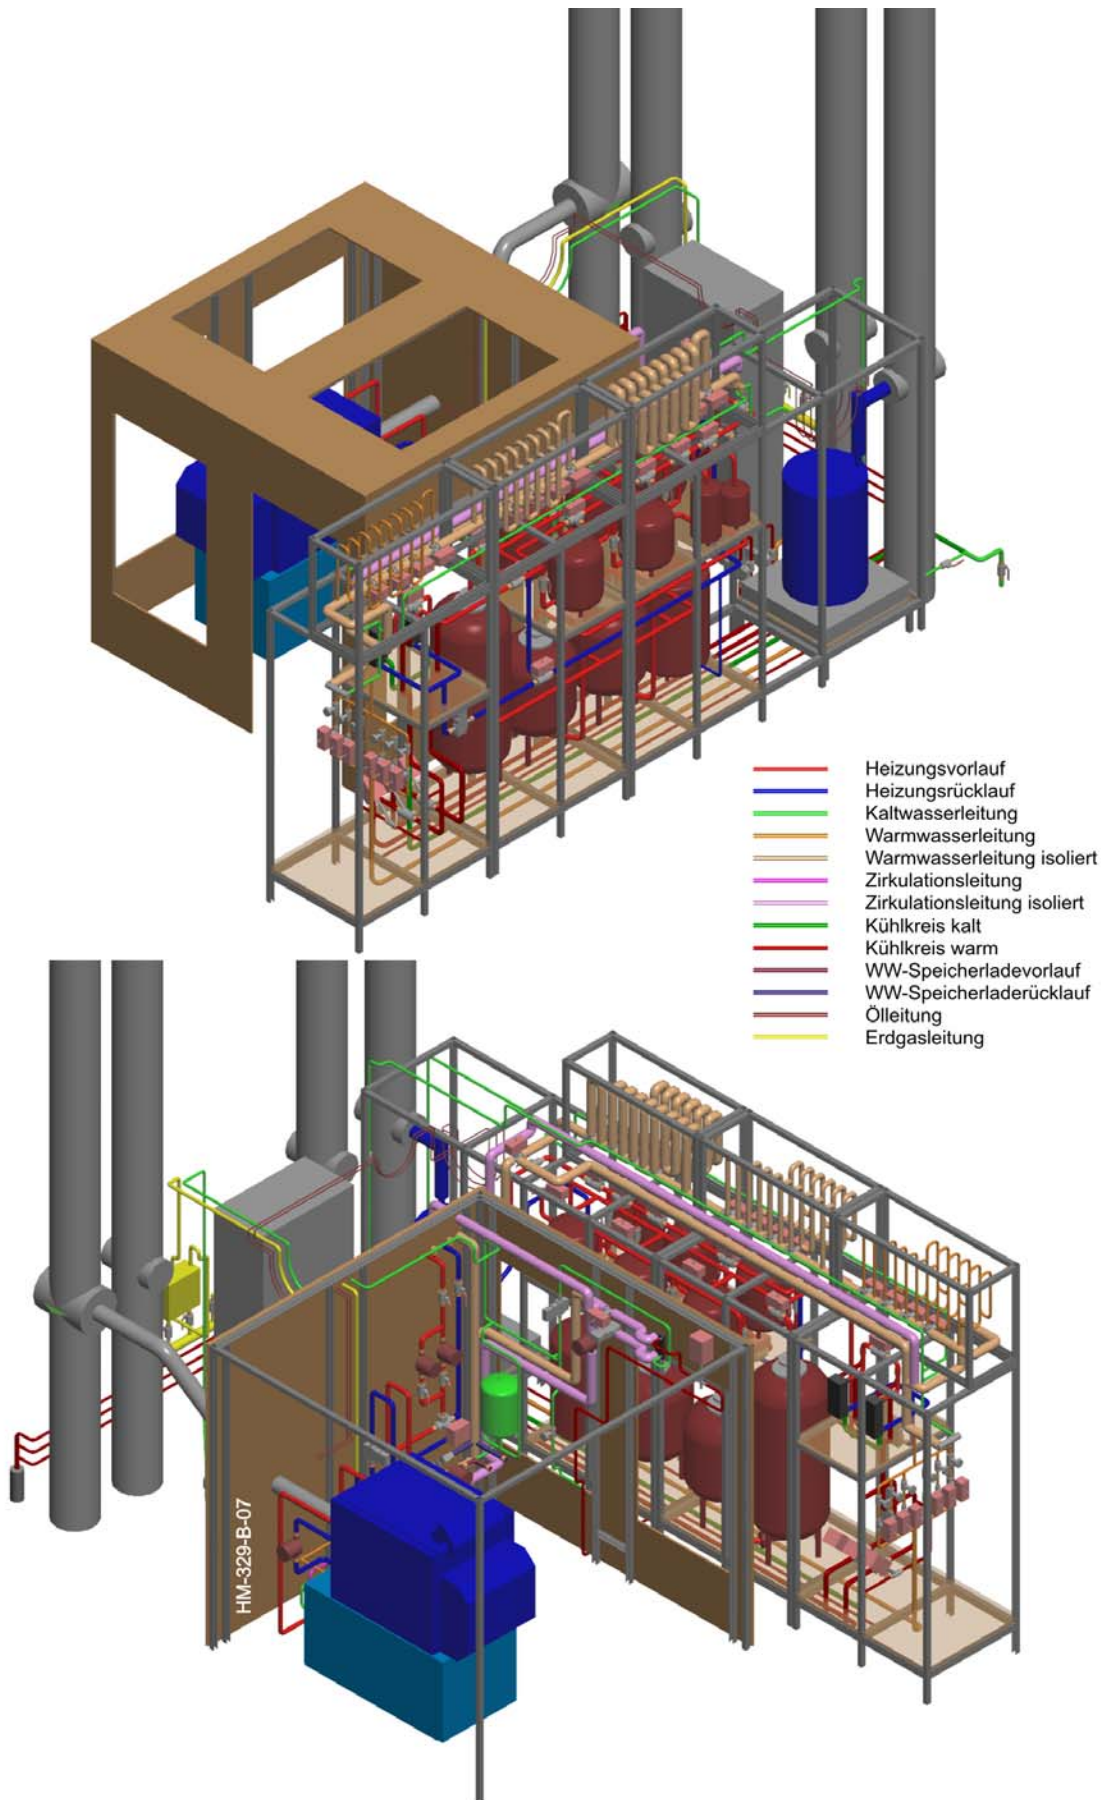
3D-Ansichten des Wärmeerzeugerprüfstands
